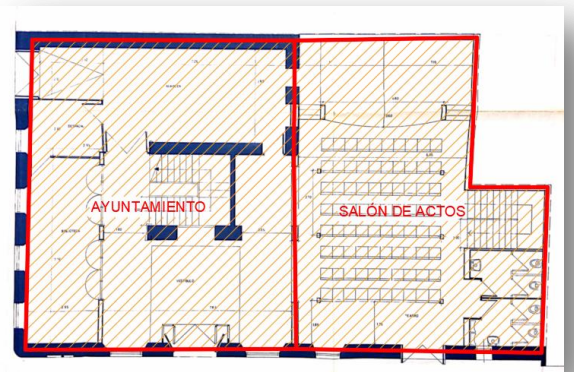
Plano viviendas. Planta baja Junio 1986/87.
